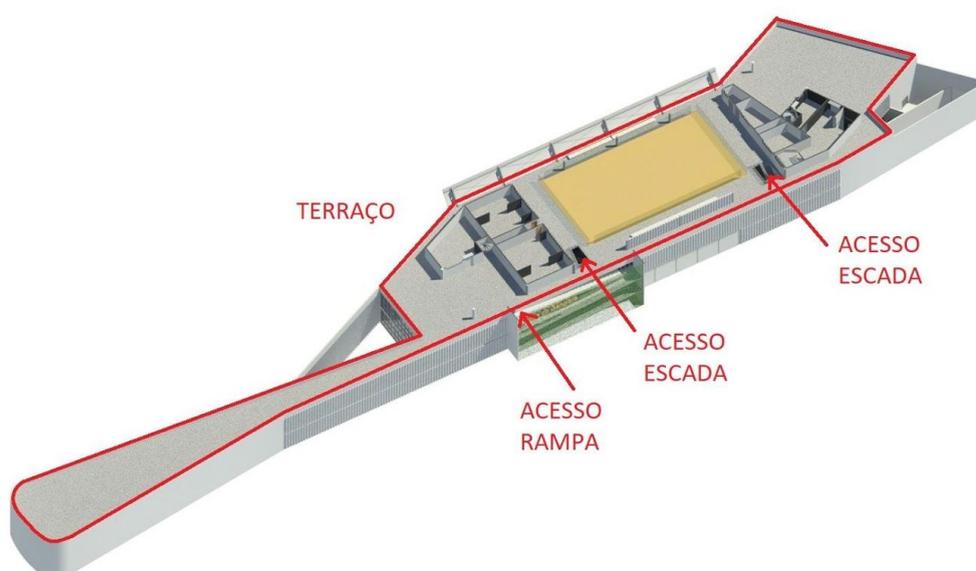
Seção Horizontal do Pavimento 1 na Volumetria do Edifício.
